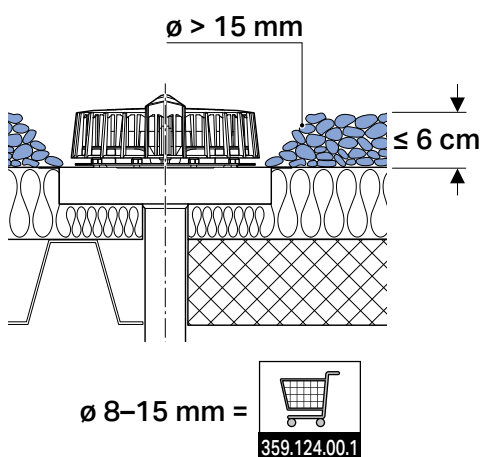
Geberit Pluvia Dachwassereinlauf 12 l und 25 l mit Dachbekiesung
